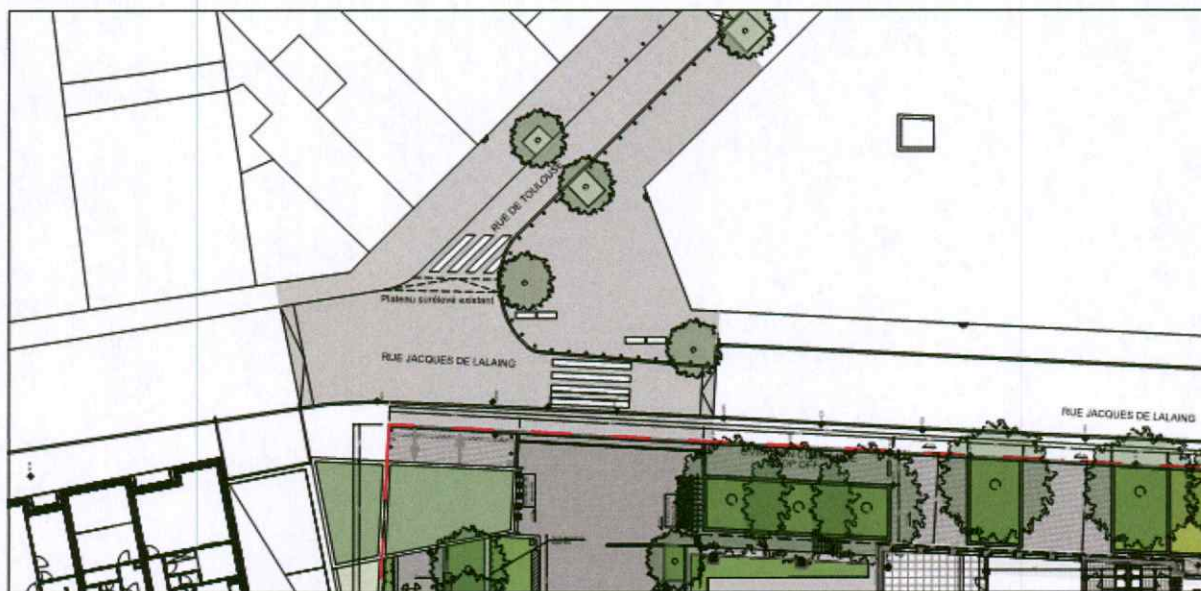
Proposition d'aménagement de l'îlot Toulouse - Lalaing
